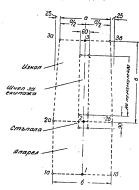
Разбивка на окоп за танк или самоходно-артилерийска установка у
